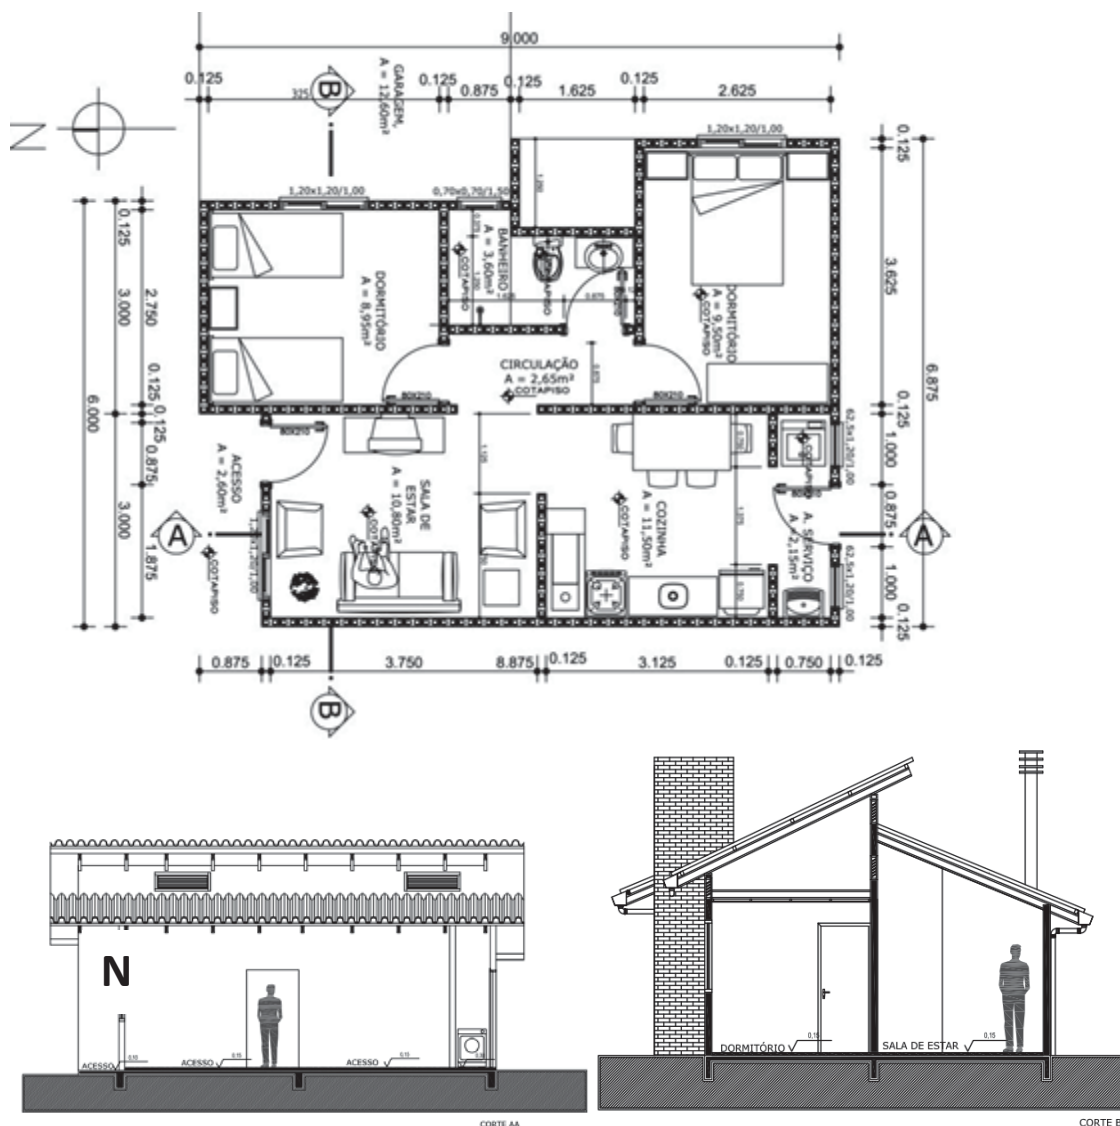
Planta Baixa do protótipo, Corte AA e Corte BB.
